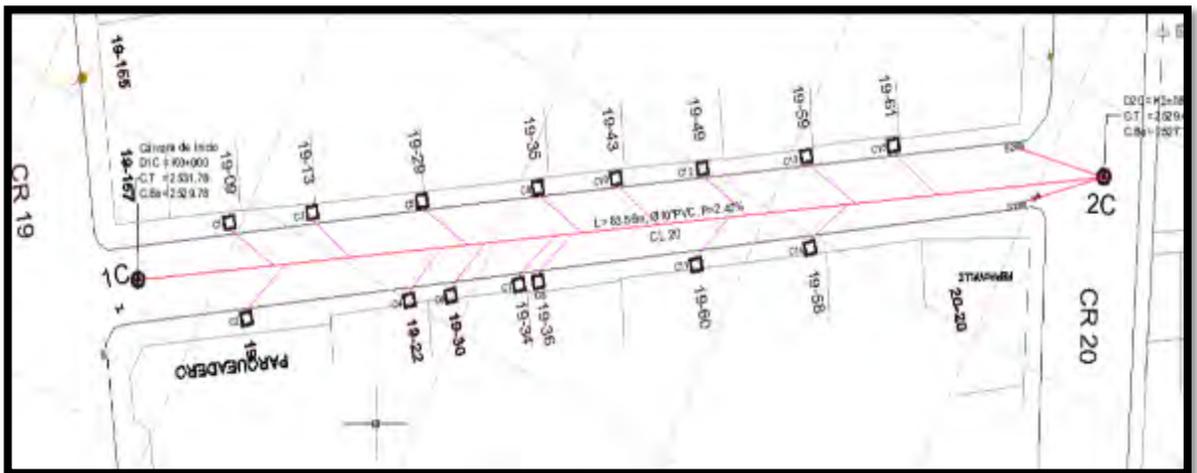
Planta de la red de alcantarillado tramo 2 (calle 20 entre carreras 20 y 22).
